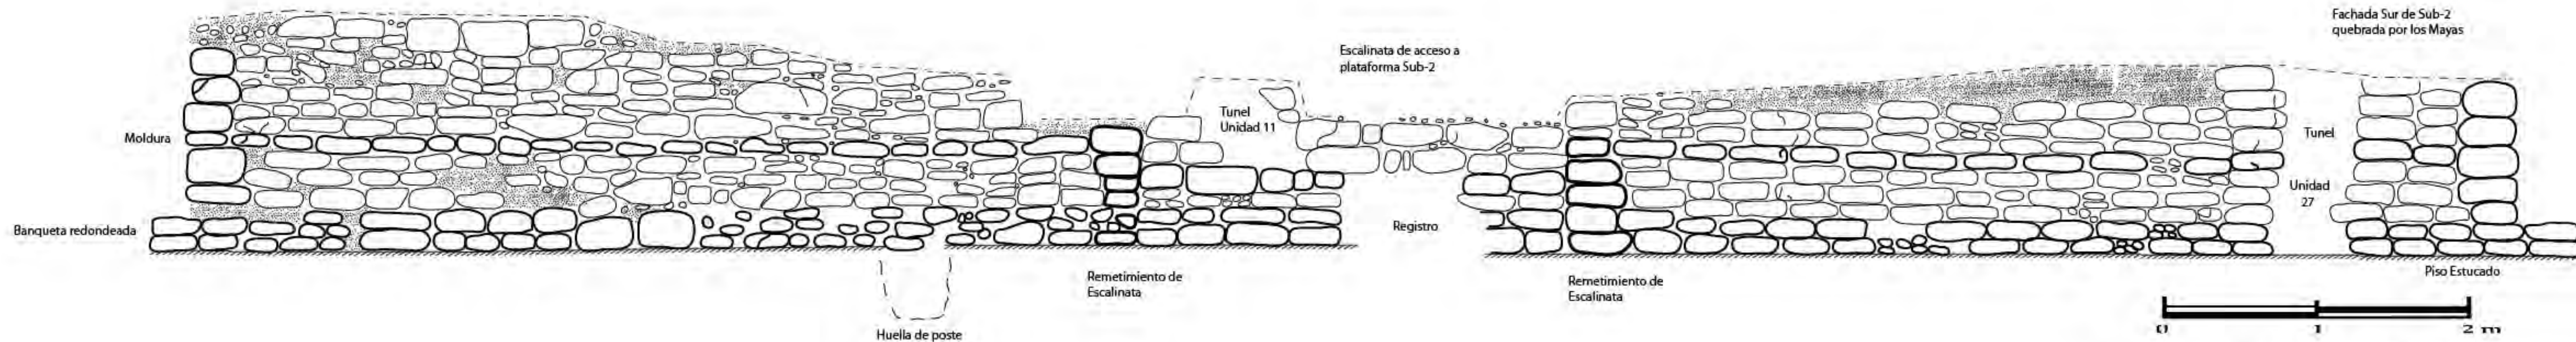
Fachada Sur de Sub-2, Estructura 12H3, Grupo B. Bloques de piedra caliza talladas con detalles de moldura en la parte media del muro. (Dibujo: D. Del Cid, 2014).
